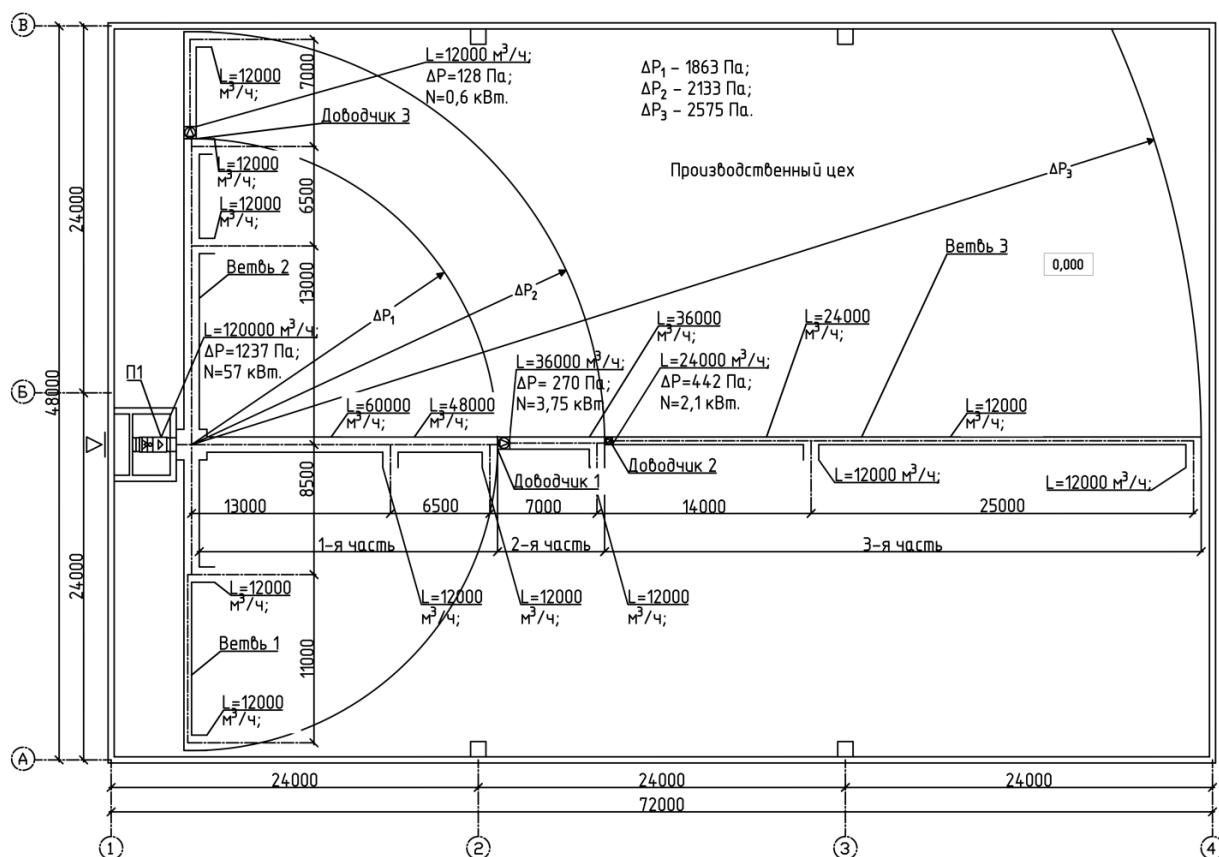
План воздуховодов вентиляционной сети с вентиляторами-доводчиками
